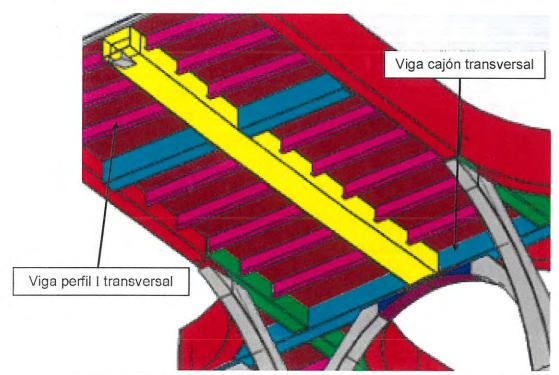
Imagen ilustrativa de vigas transversales en cajón y perfil I.
